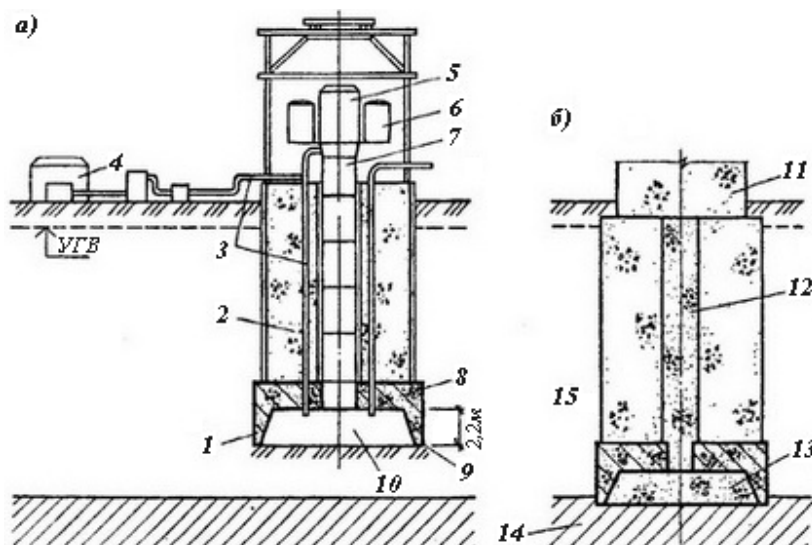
Кессон: а — погружение кессона; б — кессонный фундамент; 1 — консоль; 2 — надкессонная кладка; 3 — трубы для сжатого воздуха; 4 — компрессорная станция; 5 — центральная шлюзовая камера; 6 — прикамерки; 7 — шахтные трубы; 8 — потолок кессона; 9 — нож; 10 — рабочая камера кессона; 11 — кладка надфундаментной части опоры; 12 — бетон заполнения шахты; 13 — бетон заполнения рабочей камеры; 14 — прочный грунт; 15 — слабый грунт.
